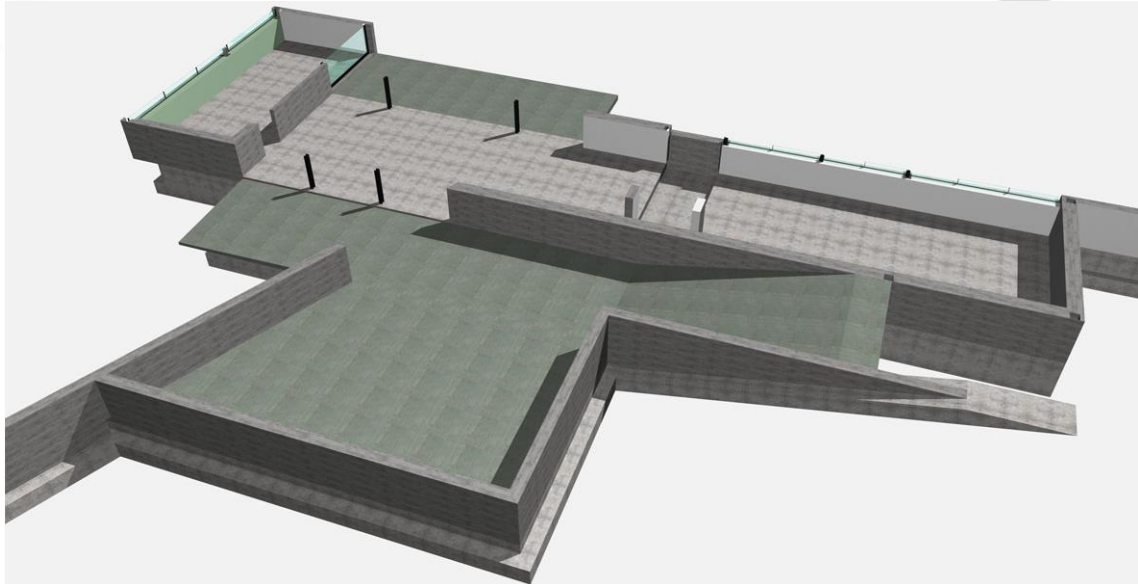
Modelo seccionado filtrado, mostrando solo los elementos estructurales.
